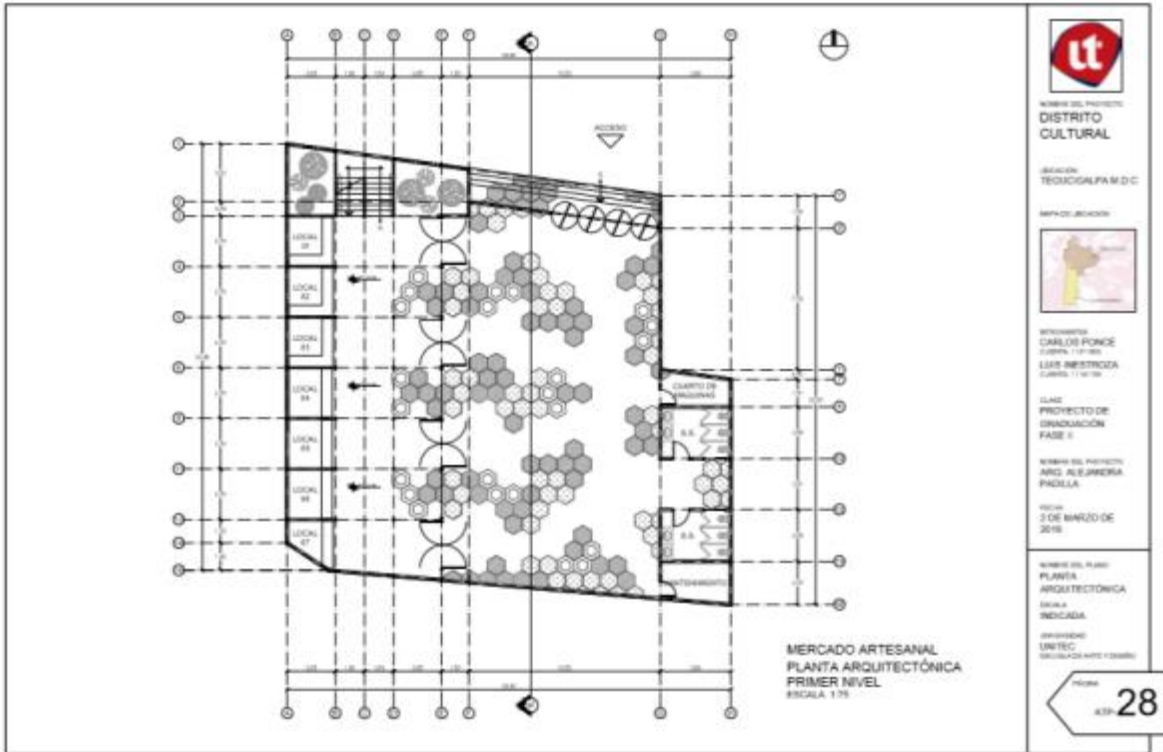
Planta Arquitectónica Mercado Artesanal Primer Nivel
